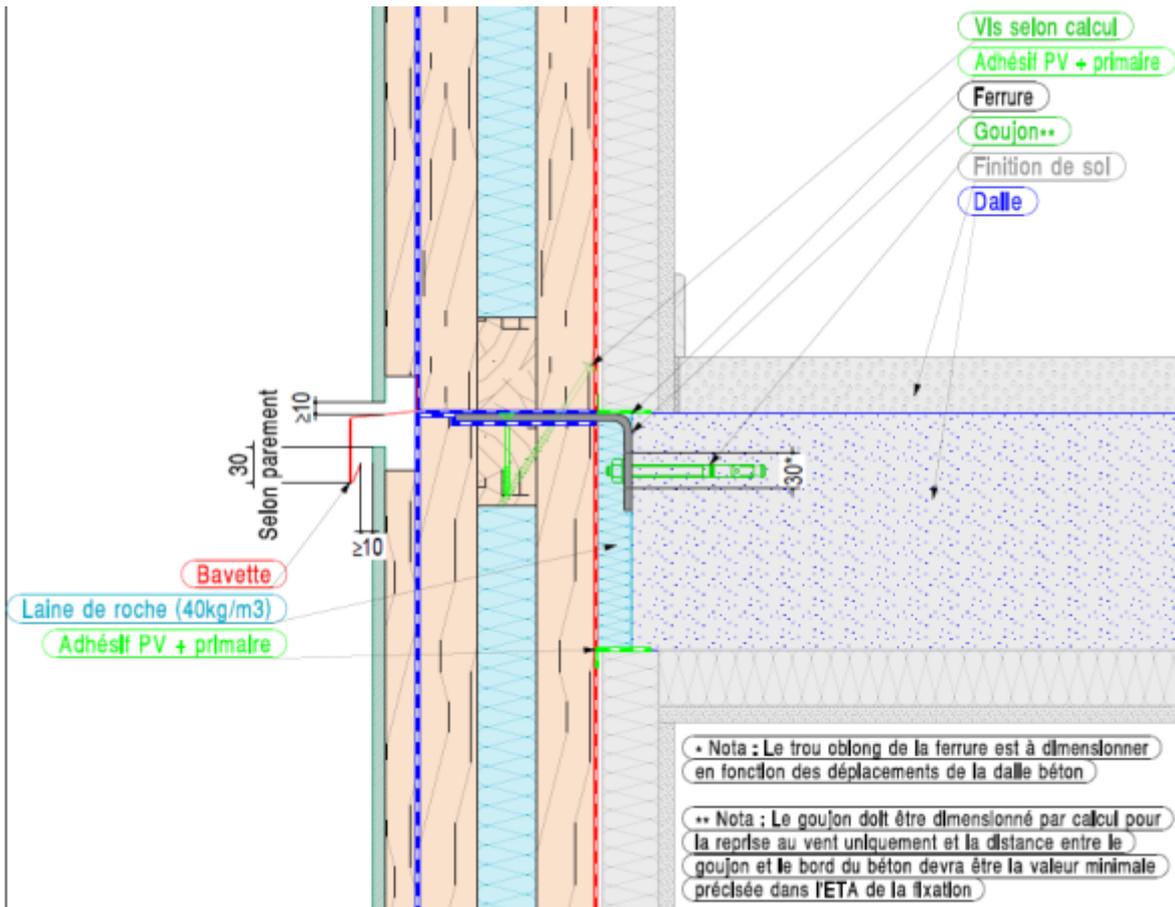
Raccord de panneaux sur dalle béton, fixation par empiement avec engravure / coupe verticale
